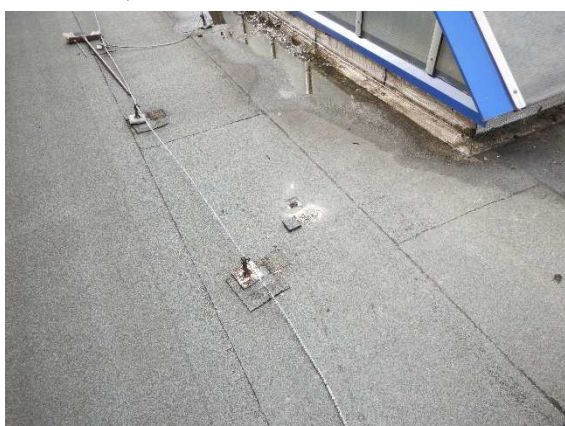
;16 - exteriér- zapravení sond ST1 a ST2;
